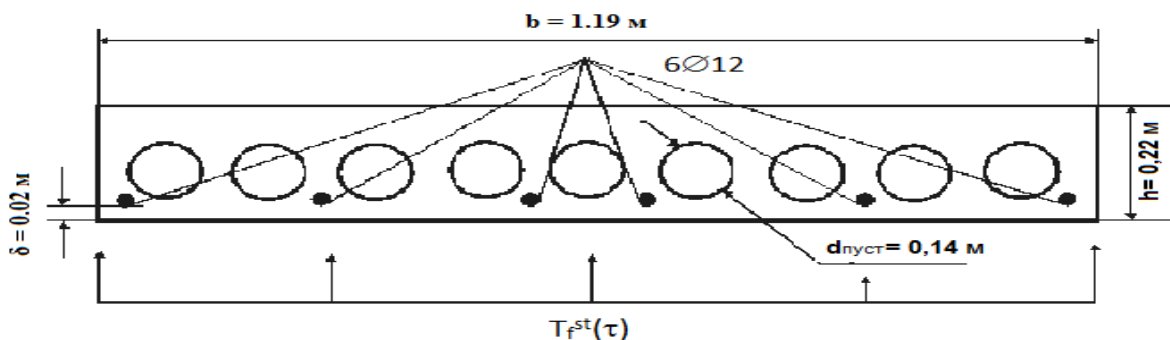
Поперечное сечение многопустотной железобетонной плиты перекрытия ПК 8-58.12
